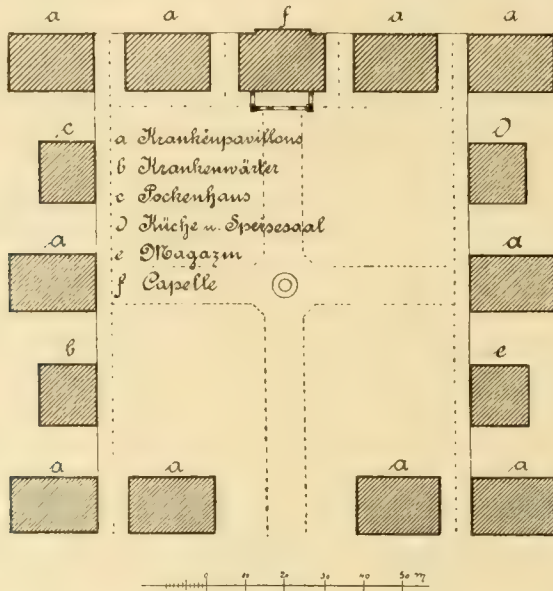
Plan des Hospitals zu Stonchouse bei Plymouth.
